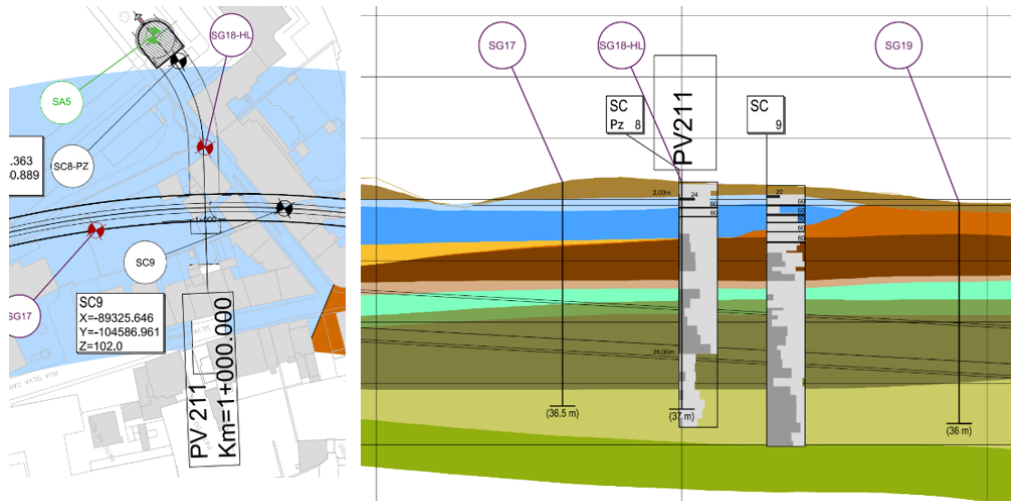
Planta e Perfil longitudinal da Geologia/ Geotecnia na zona do PV11.
